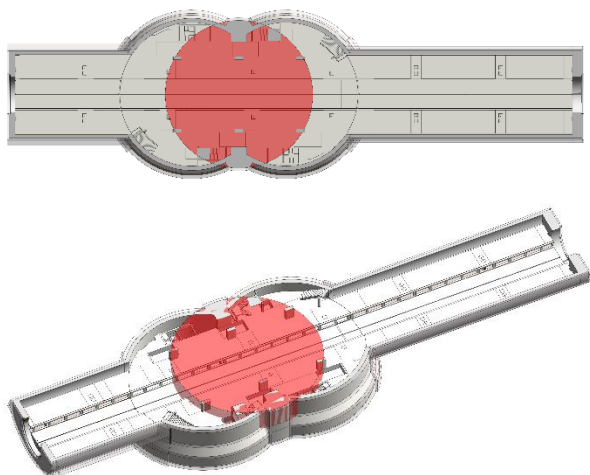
Vistas en planta e isométrica del pozo de la estación junto con el pozo de ataque en rojo.
